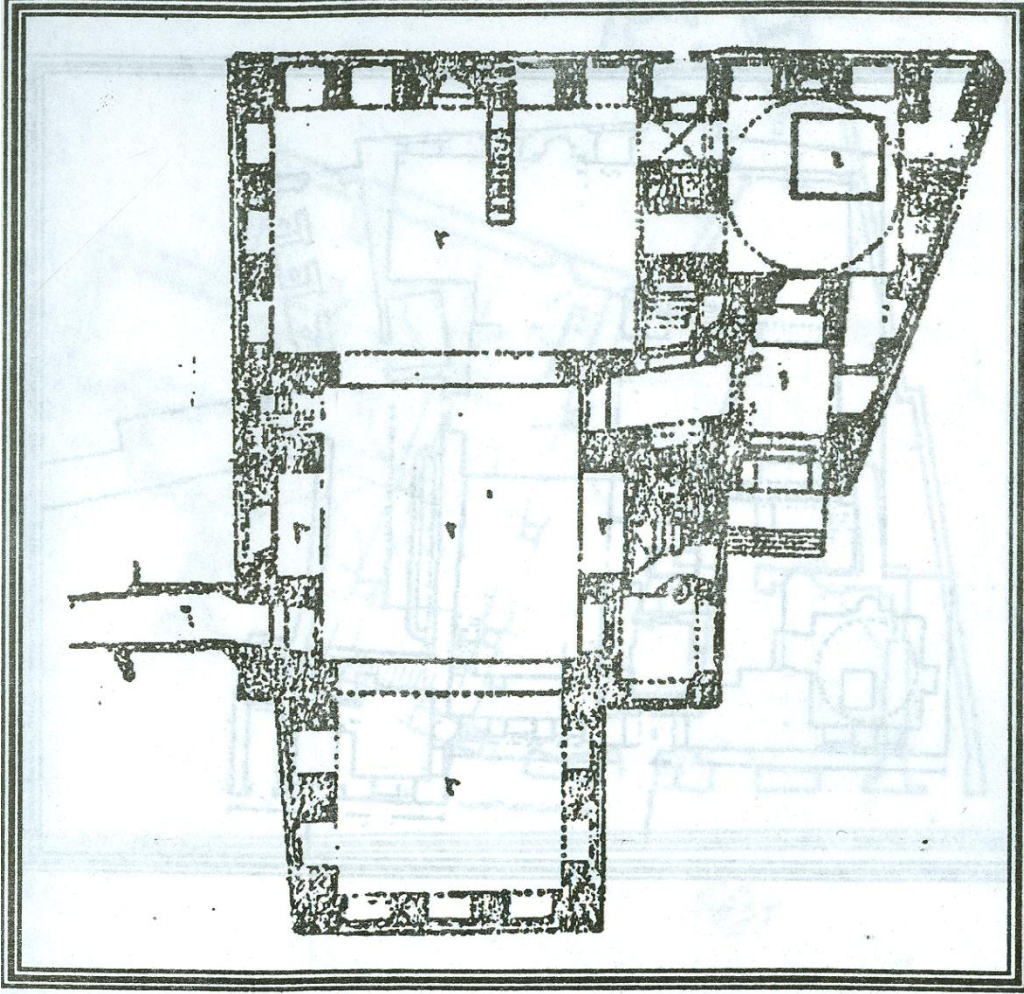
مسقط أفقي لجامع المؤيد شيخ، عن: مركز تسجيل الآثار
